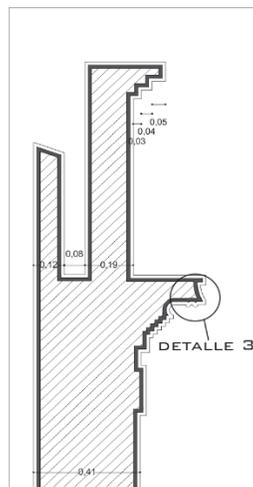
Sección C-C, detalle cornisa, Estación del ferrocarril Sur.
